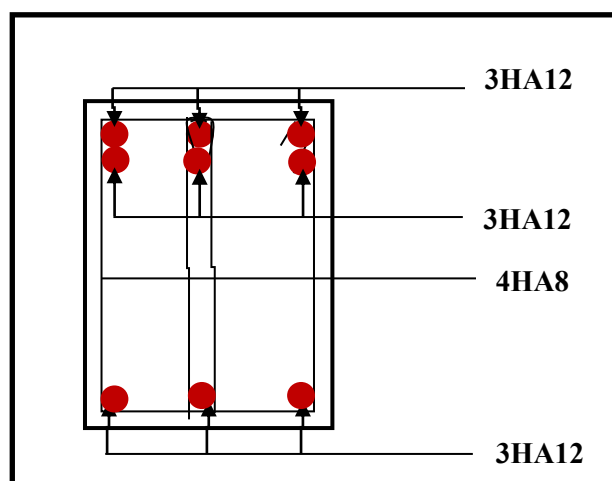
Ferrailage aux appuis d'une poutre secondaire.
